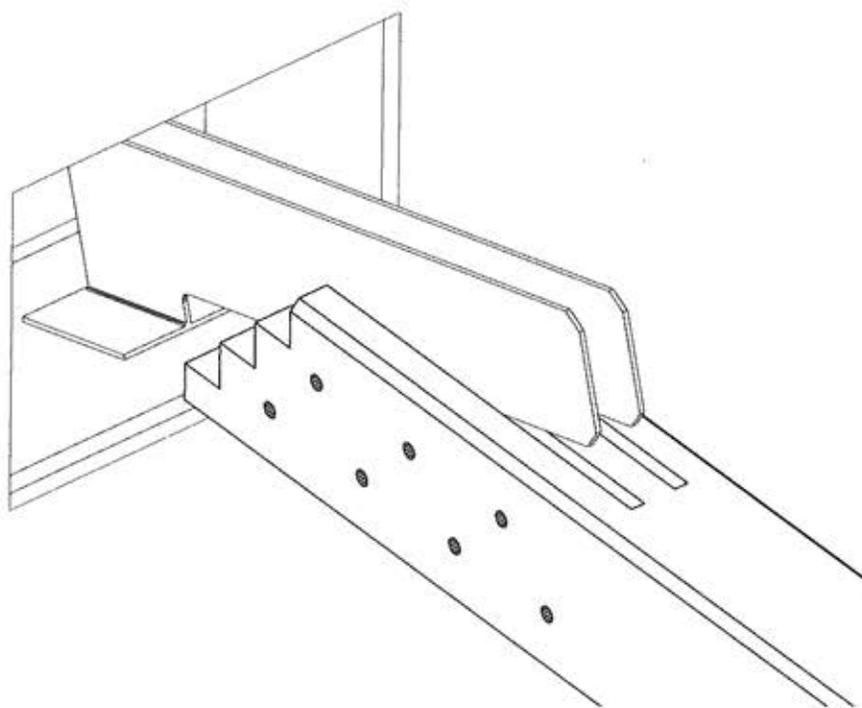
b – Ricostruzione dell'appoggio della trave con protesi costituita da profilati piatti d'acciaio. Fase 2: inserimento dei profilati piatti d'acciaio all'interno dei tagli (M. Mariani).
